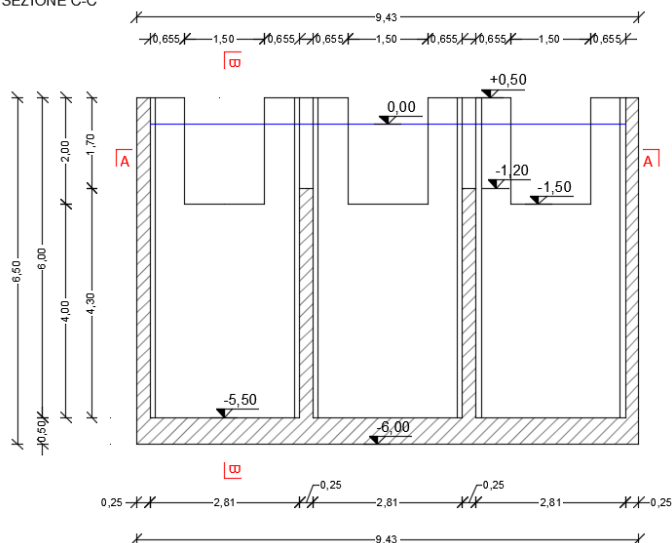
Cassone tipo G3: carpenteria – Sezione verticale C-C
